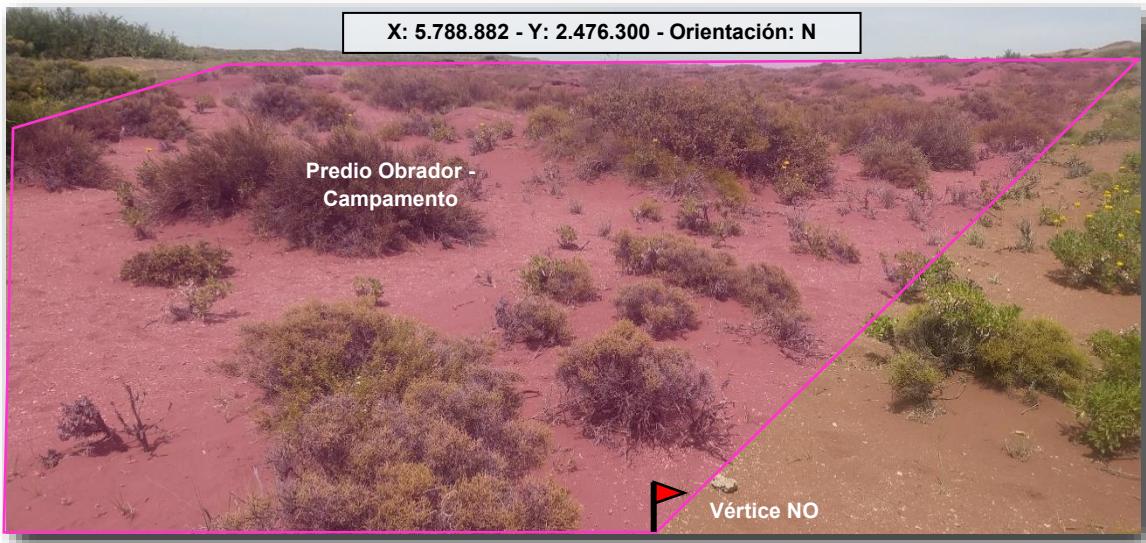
Vista del futuro predio obrador- campamento desde el esquinero Noroeste.
